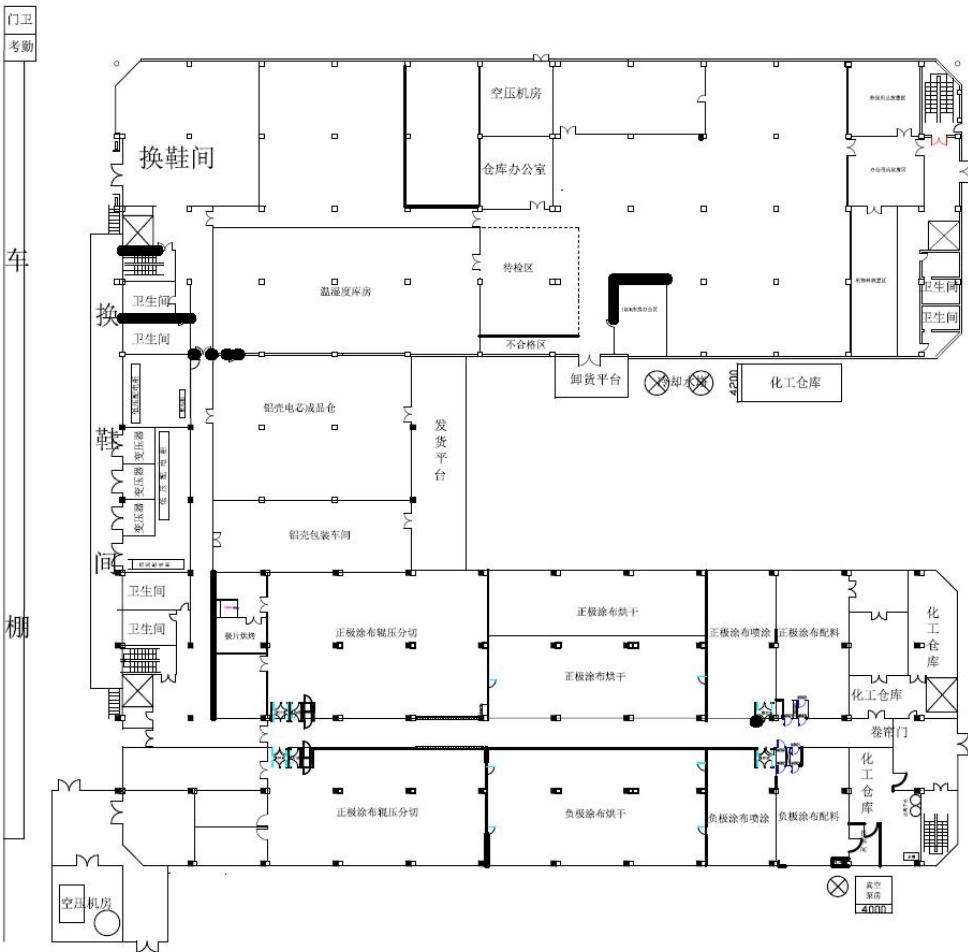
港西大道厂区 CD 栋一楼平面图
